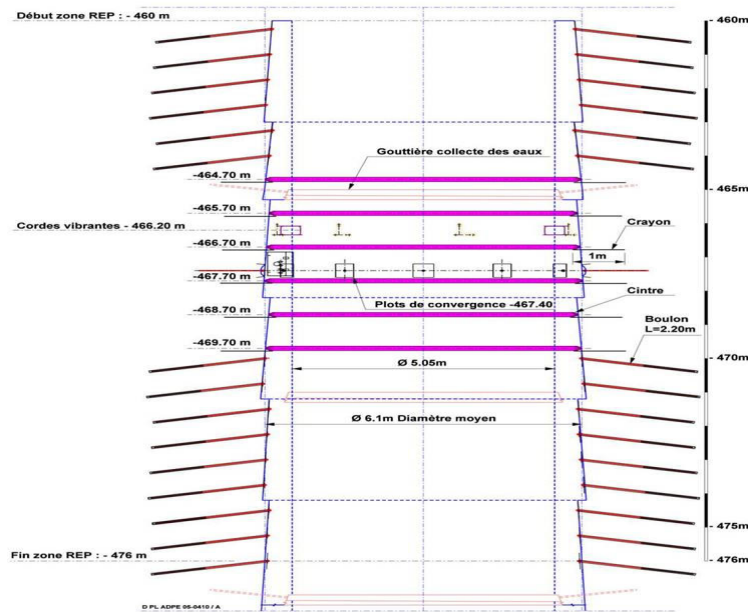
Coupe du puits d'accès entre les cotes -460 m et 475 m
